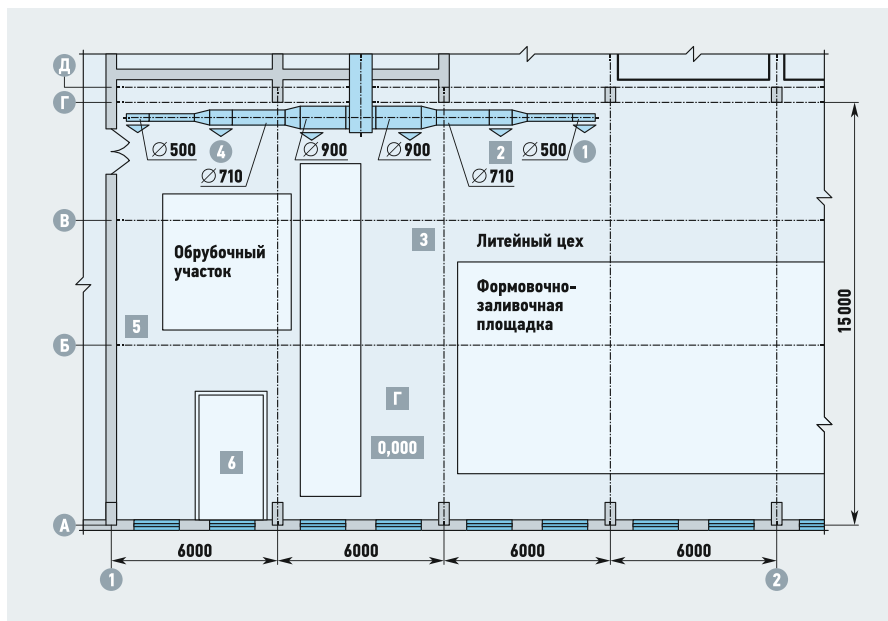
Фрагмент плана литейного цеха (1 и 4 — бегуны смесительные; 2 — печь разогрева ковша; 3 — землесейлка; 5 — заточной станок; 6 — голтовочный барабан)
